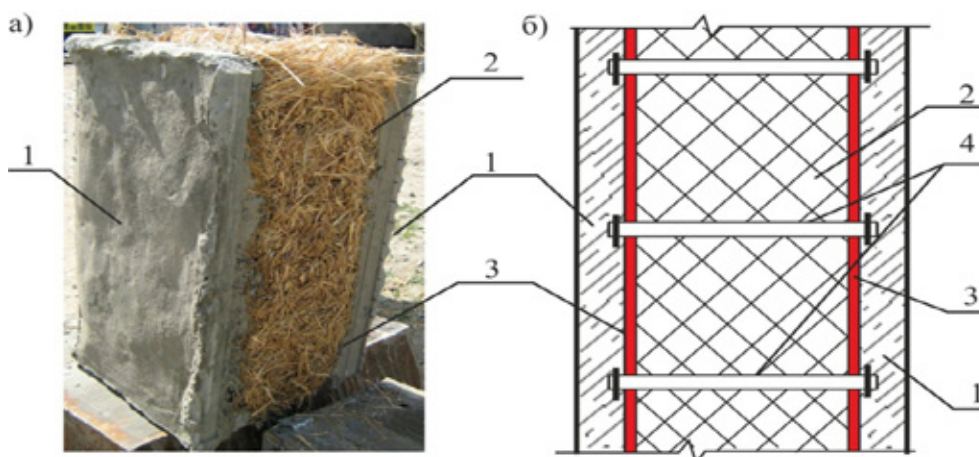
Новая конструкция многослойная конструкция стены: а – общий вид; б – поперечный разрез:
